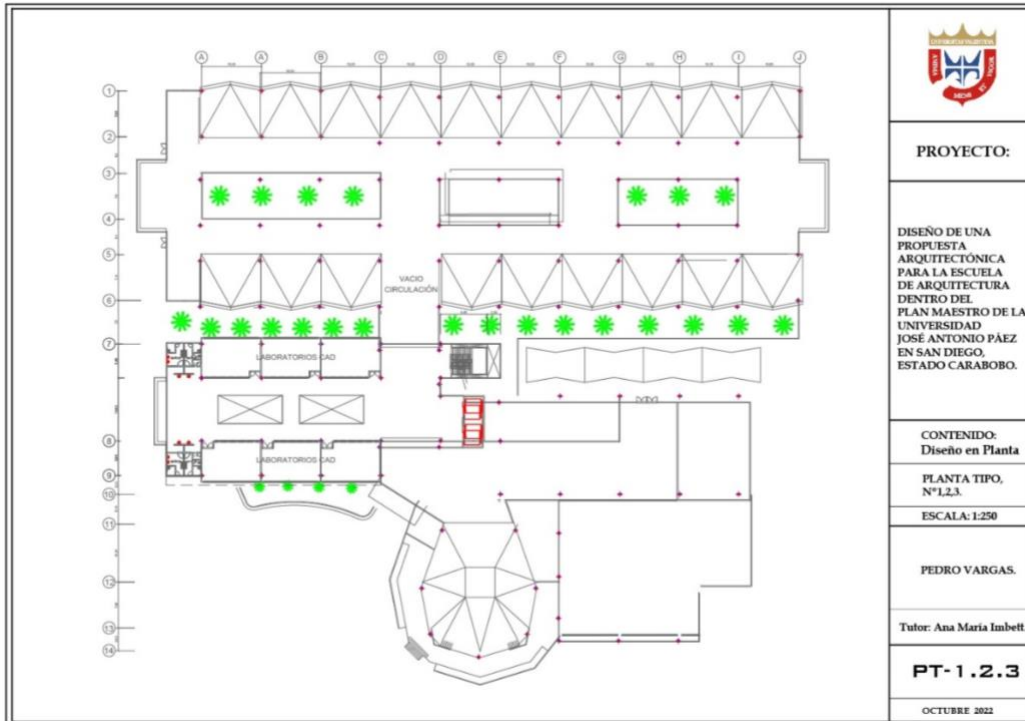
Plano de diseño en vista de planta para los pisos tipo 1,2,3.
